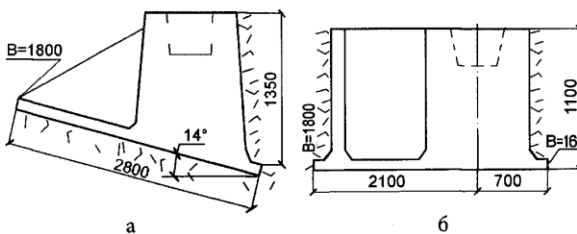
Блоковий фундамент із розвинутою похилою підшовою (а) та з додатковою вертикальною стінкою (б).
